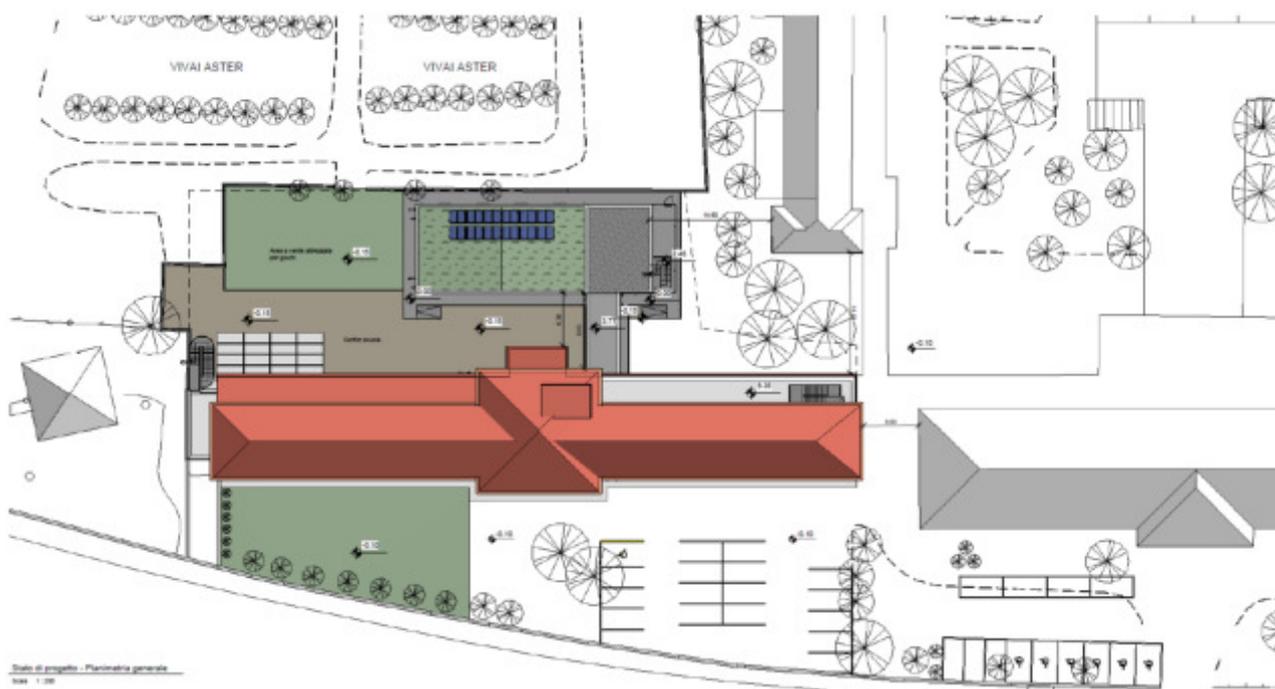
Planimetrie sistemazione esterna – stato di progetto
